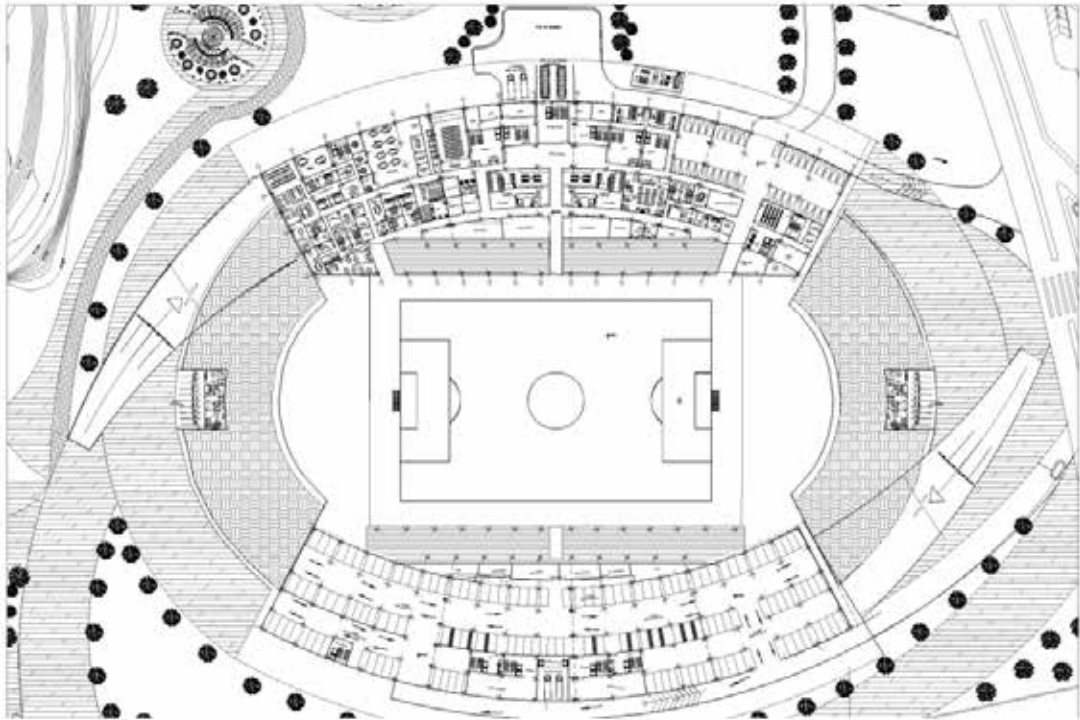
Planta Nivel Sótano 1, Nivel de Juego.
